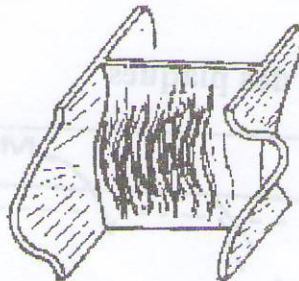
voilement de l'âme et des semelles d'une poutre comprimée
